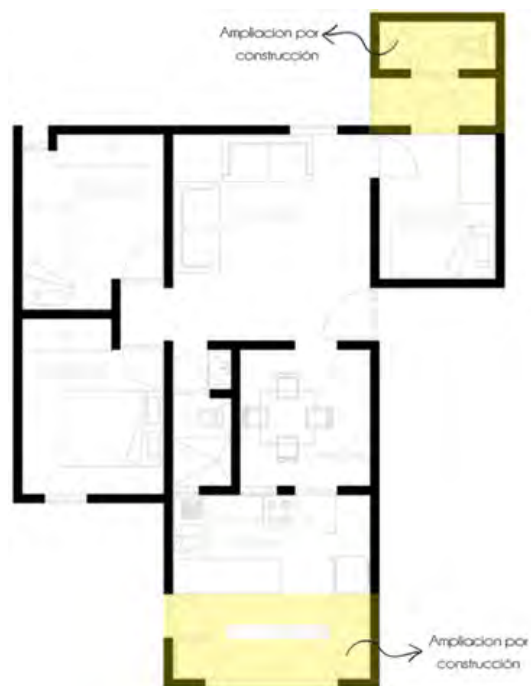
Plano con indicaciones de ampliación por construcción.
